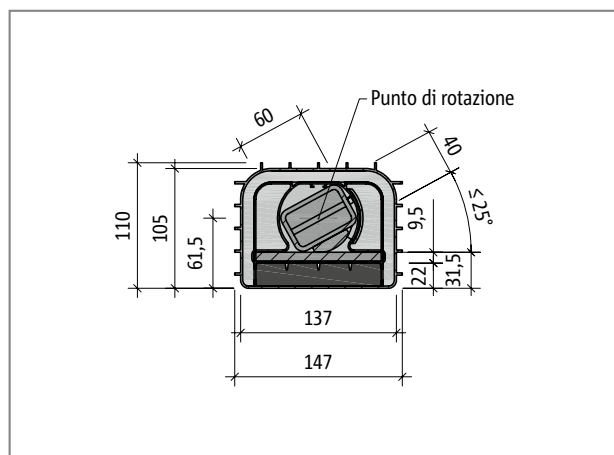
Schöck Tronsole® tipo Q, sezione trasversale con elemento portante girato
